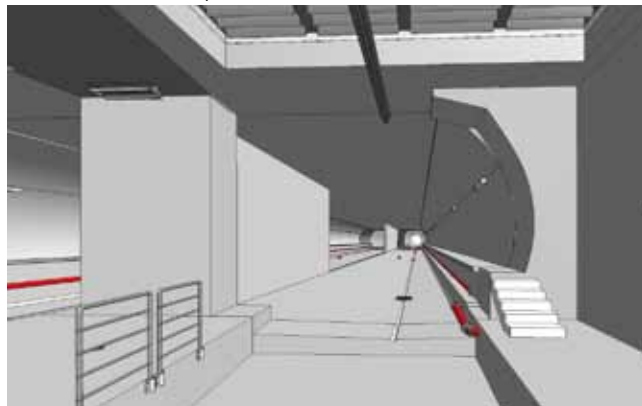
Vistas de la caverna en 3D. Modelos con Revit
